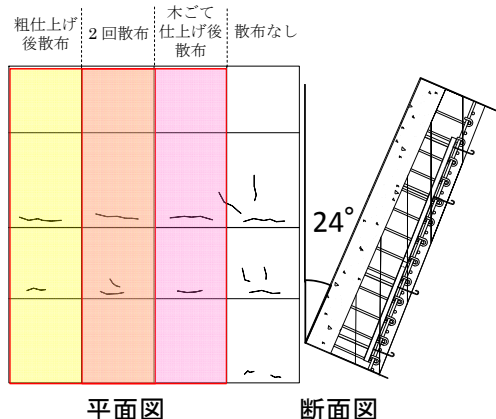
第 2 リフトモックアップ試験 ひび割れ発生状況
